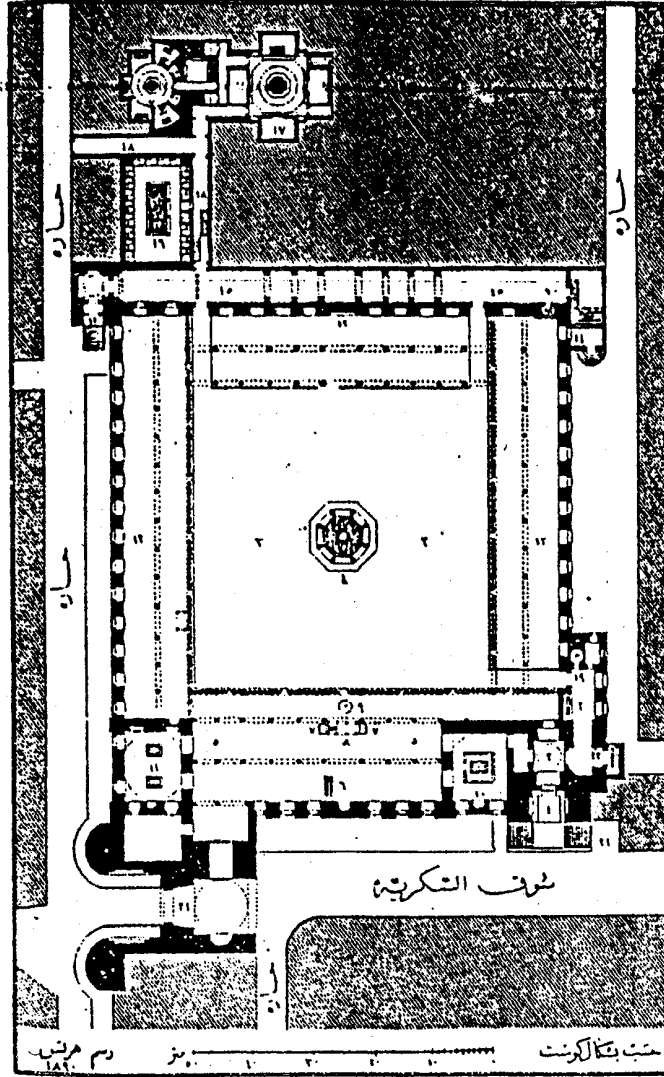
مسقط أفقي لجامع مسيح باشا المعروف
